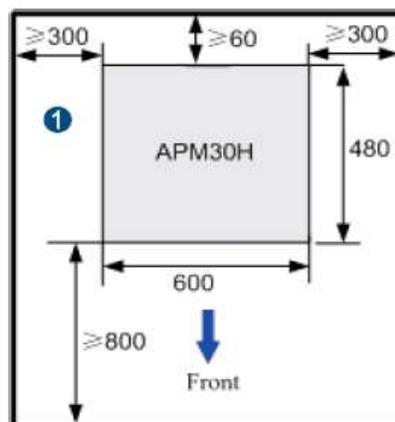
Dimensiones mínimas necesarias para montaje de APM30
